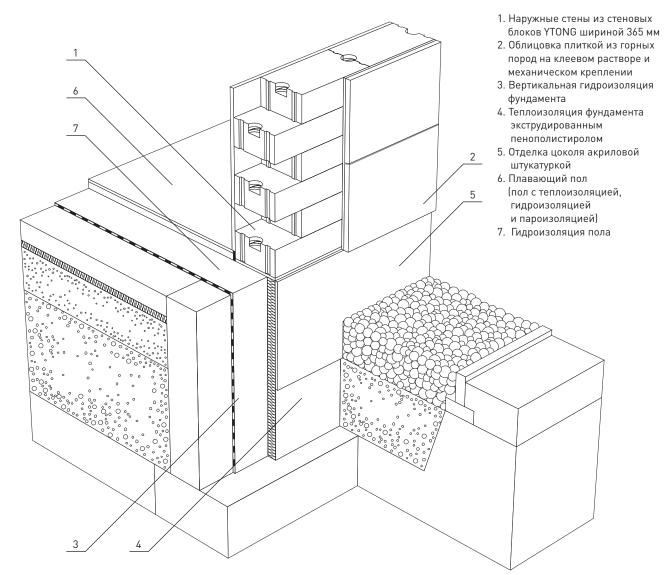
Цокольная часть здания по системе YTONG, без подвала, с полом на грунте
